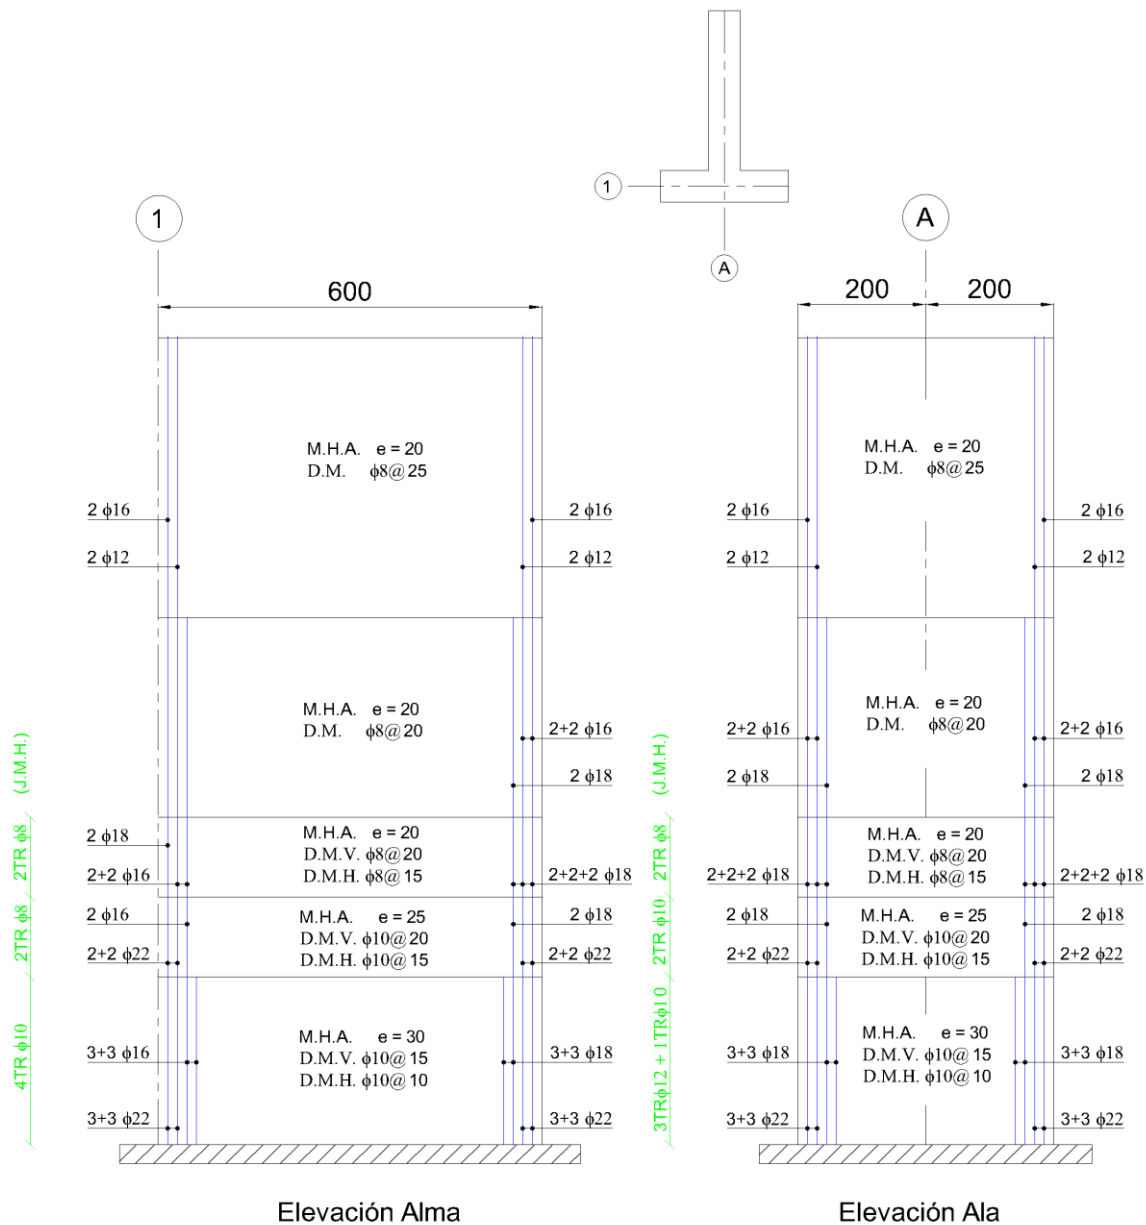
Plano (con vista en elevación) del muro MT1.
